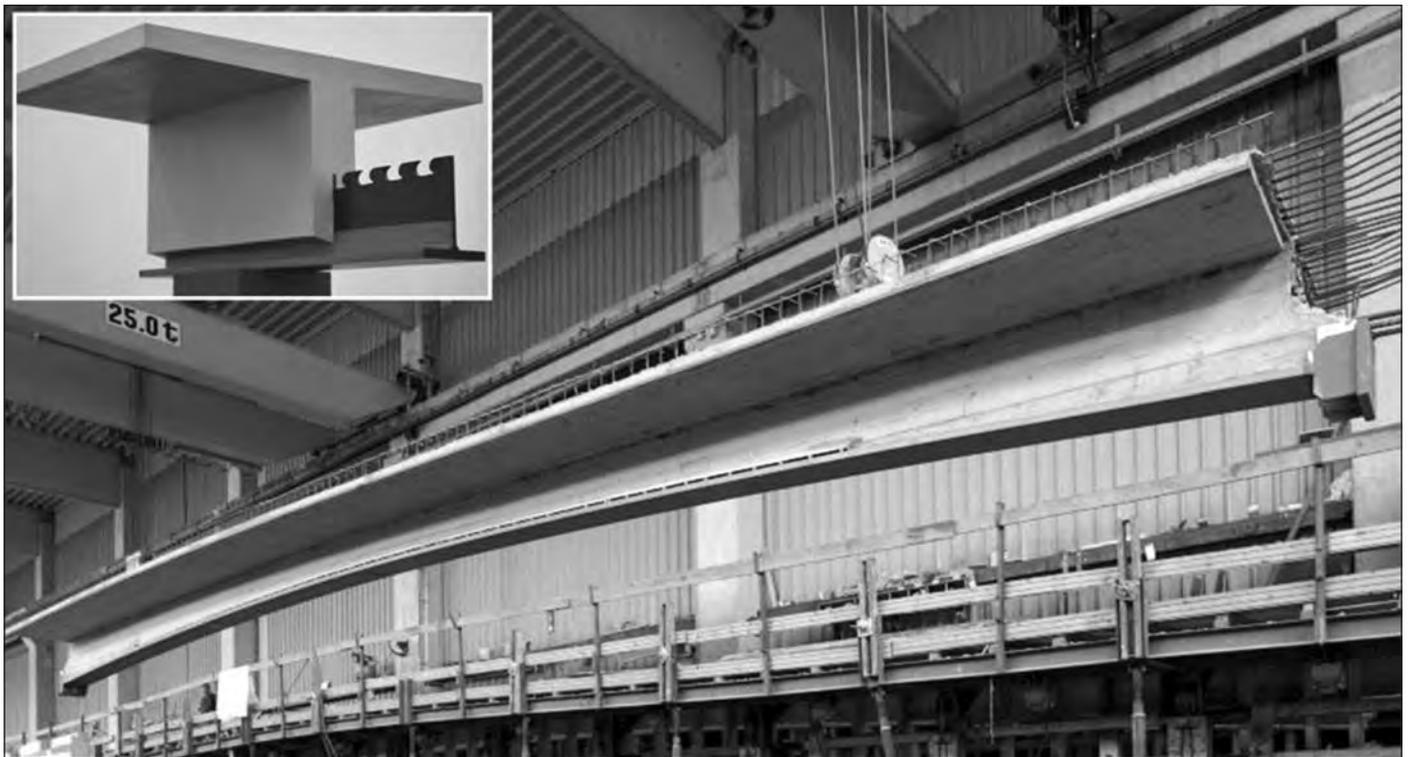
Poutre Préco préfabriquée en atelier pour le pont de Kuchl (Autriche)
